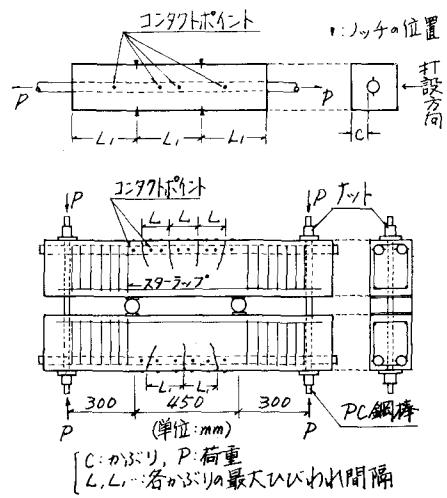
両引張試験体形状およびはり供試体ひびわれ発生状況
